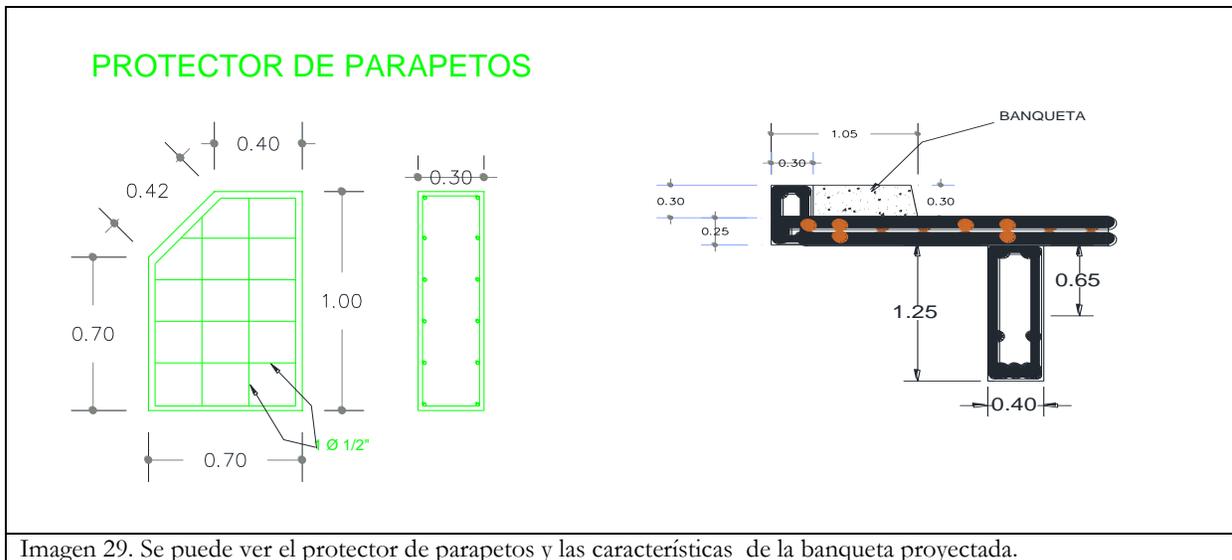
Se puede ver el protector de parapetos y las características de la banqueta proyectada.
